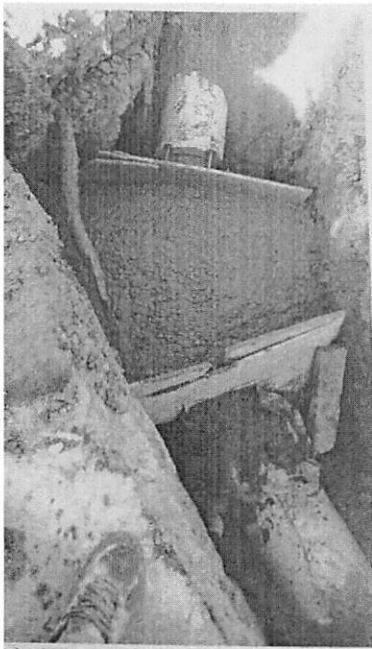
Anclaje de Hormigón Armado en Cruce de Puente.
